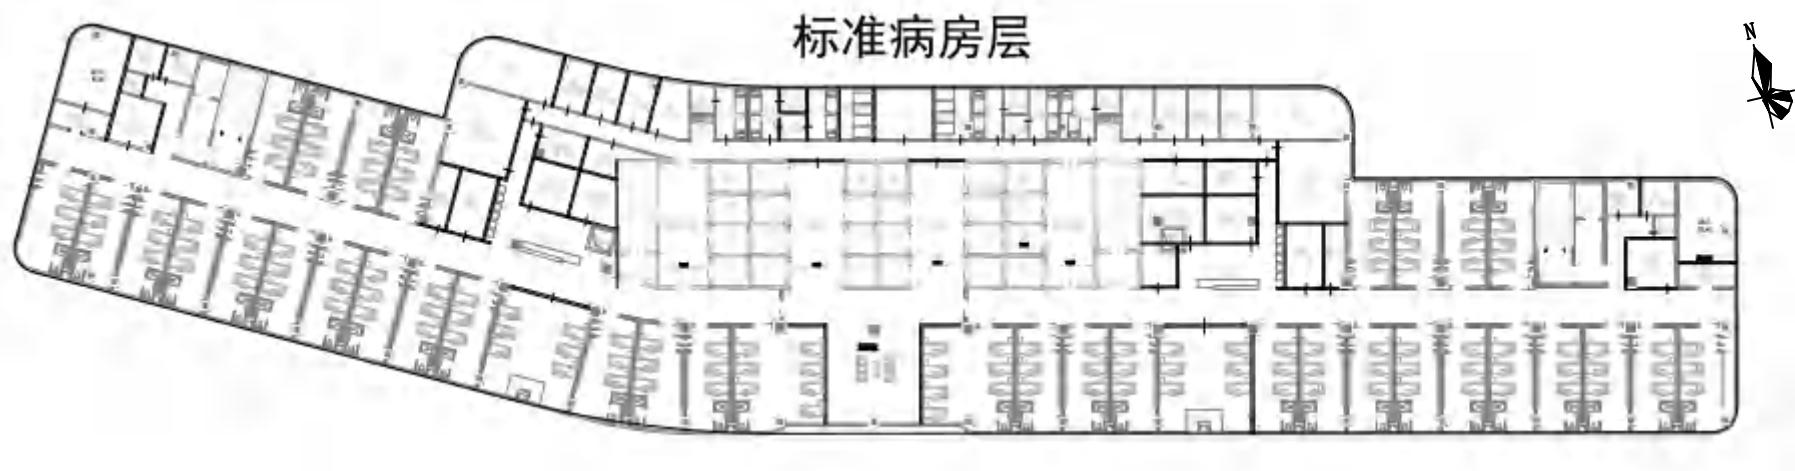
项目医疗综合楼九层~十八层、二十层平面布置图（比例尺：1:664）
